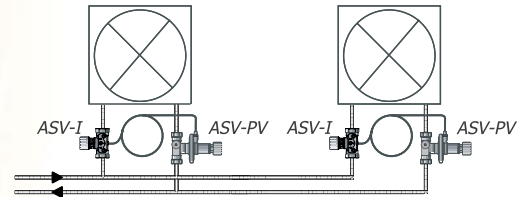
Схема об'язки нагрівальних або охолоджувальних вентиляторних конвекторів (fan coils)
